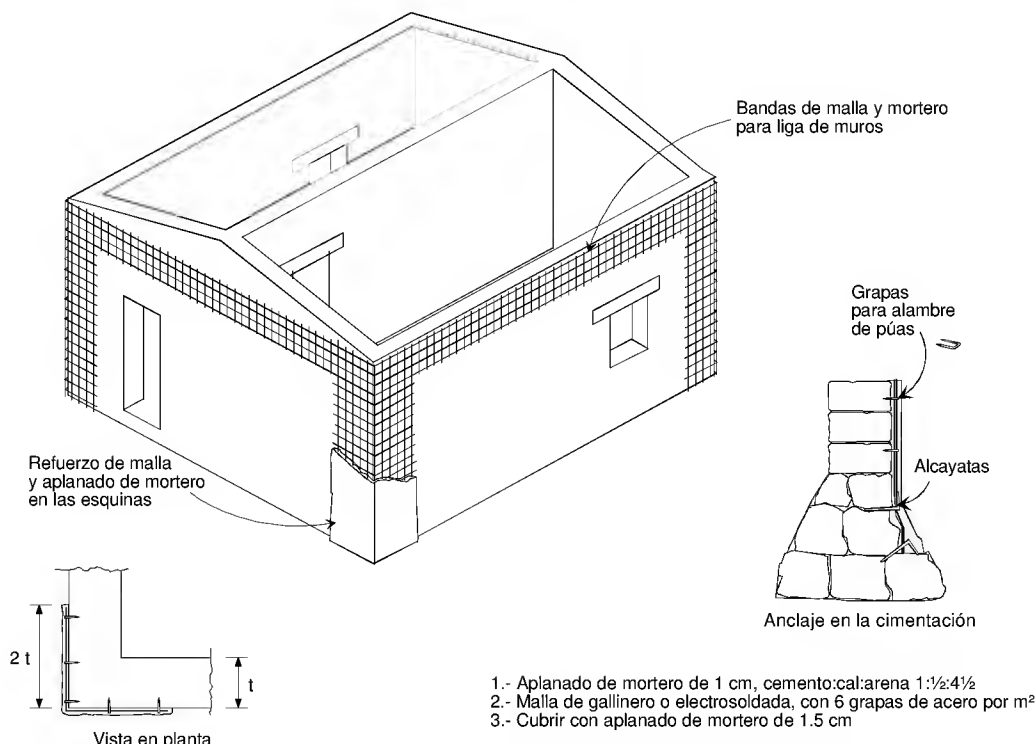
Bandas de malla y mortero en las esquinas y la parte superior de muros
